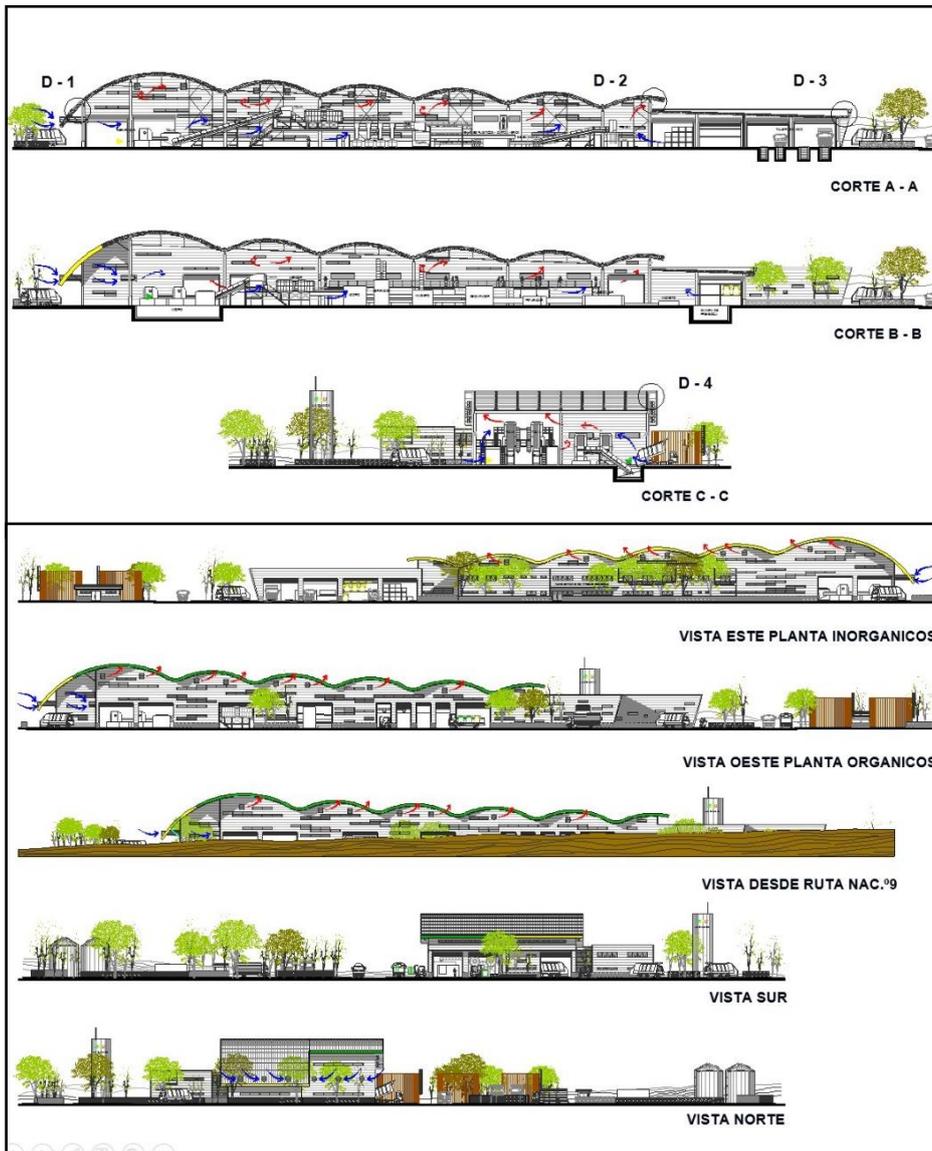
Plano de Cortes y Elevaciones, Planta de tratamiento de “RSU” con producción de energías renovables-Empresa COGERSA. Fuente: <http://www.cogersa.es/metaspacesportal/14498/19176> edición: propia 2017
